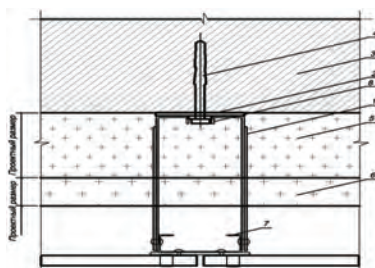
Вертикальный узел крепления навесных фасадных систем
